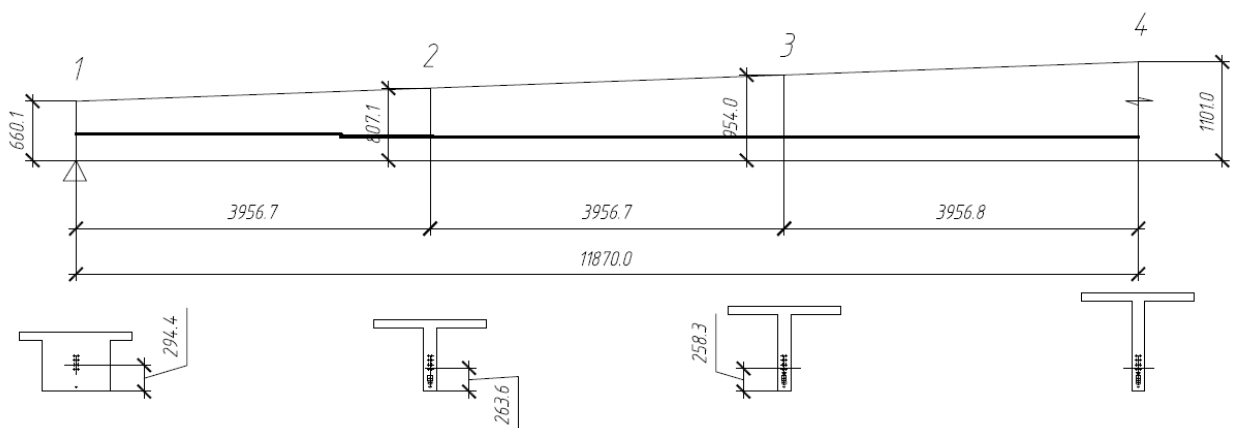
Схемы приведённых сечений в точках 1–4 плиты перекрытия «Чайка»
